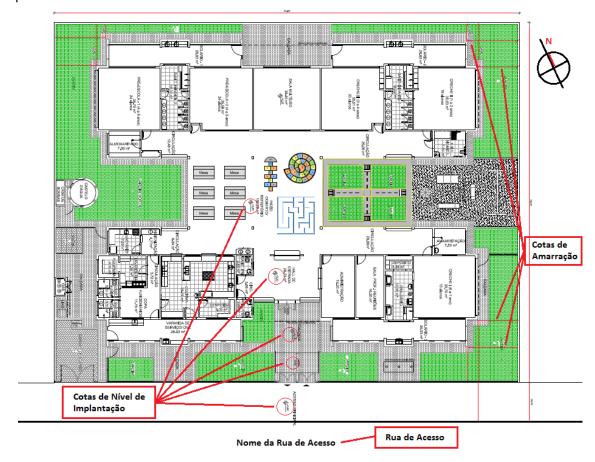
Exemplo de "Planta de Locação" da obra da Creche Tipo 2.
